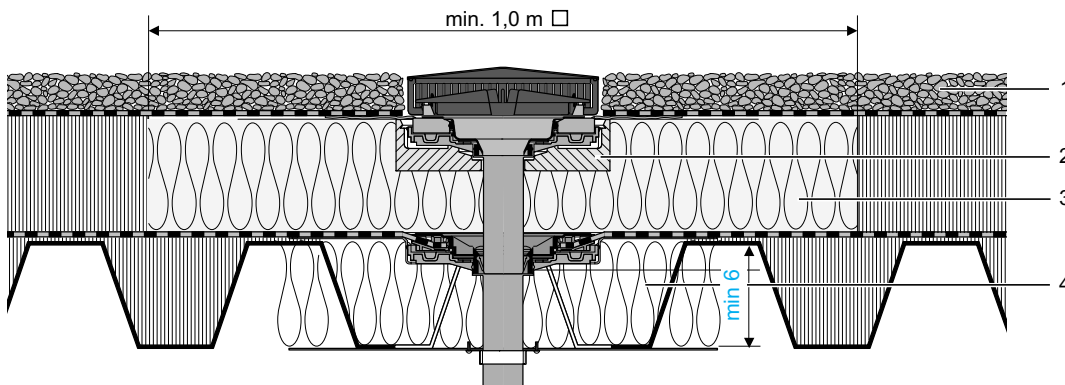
Dachaufbau Leichtbau gedämmt mit Geberit Pluvia Dachwassereinlauf und Geberit Pluvia Dachdurchführung mit Brandschutz
